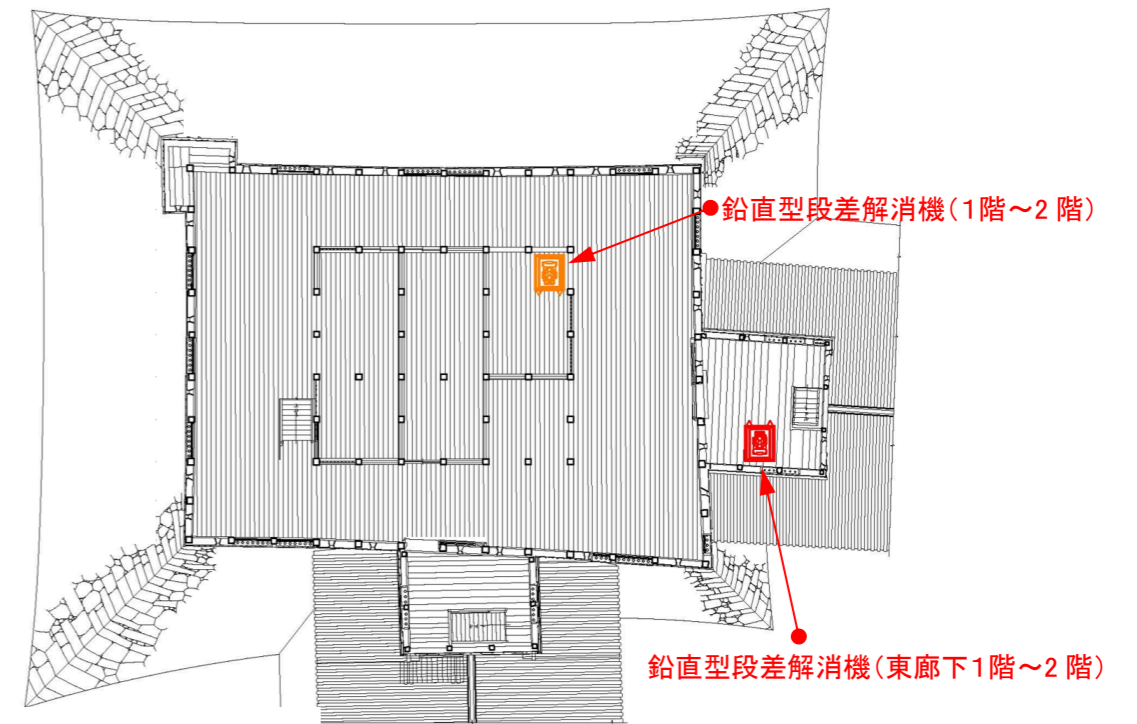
天守1階平面図及び東廊下・南廊下2階平面図（復元原案）
